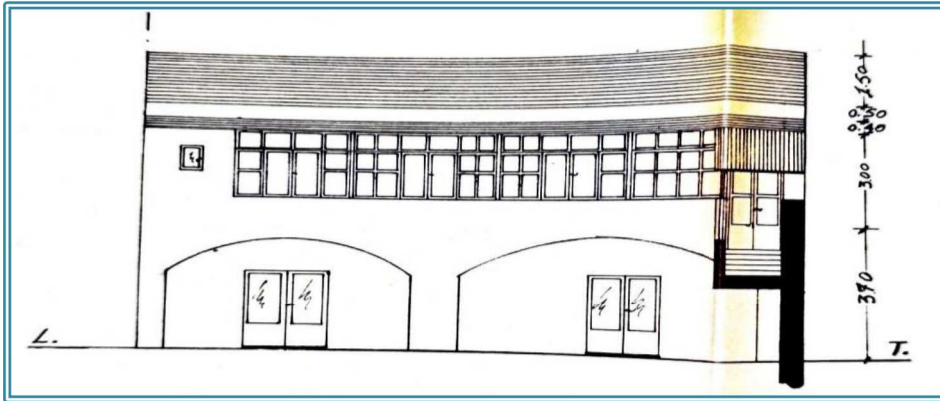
Prospetto (post operam) – estratto dal fascicolo pratica di costruzione edile n. 5951 del 17.03.1988
